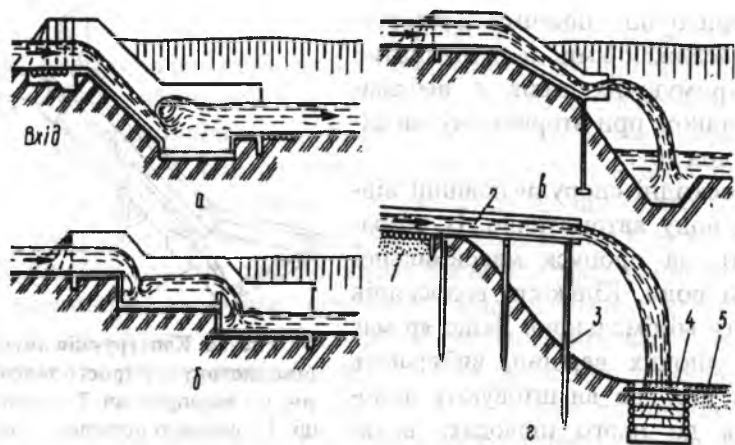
Вершинні водоскидні споруди: а – швидкотік; б – перепад; в – консоль з похилим лотком; г – консоль з прямим лотком; 1 – закріплена вершина яру; 2 – струменевоспрямовуючий лоток; 3 – опора лотка; 4 – водобійний колодязь; 5 – укріплена частина днища яру
